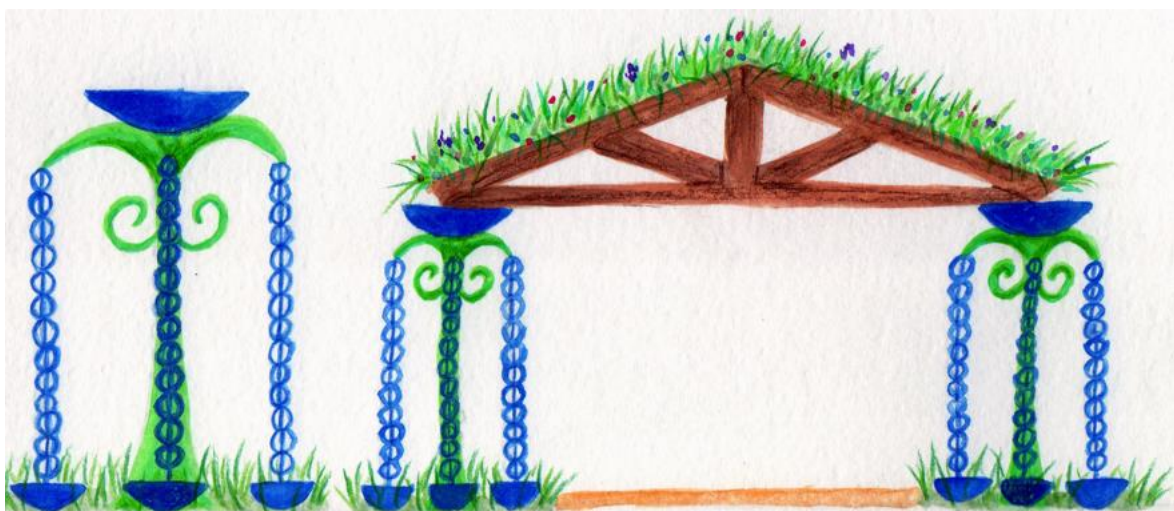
Particolare tetto verde con elemento decorativo strutturale
